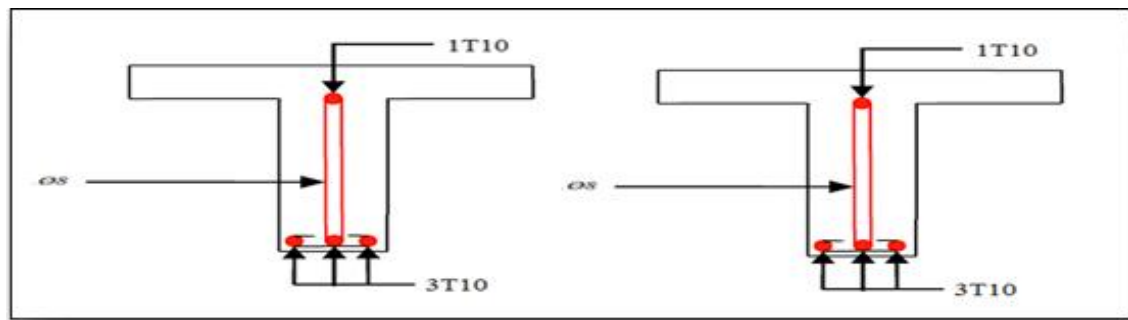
Ferrailage des poutrelles de rive (RDC, étages courants)
